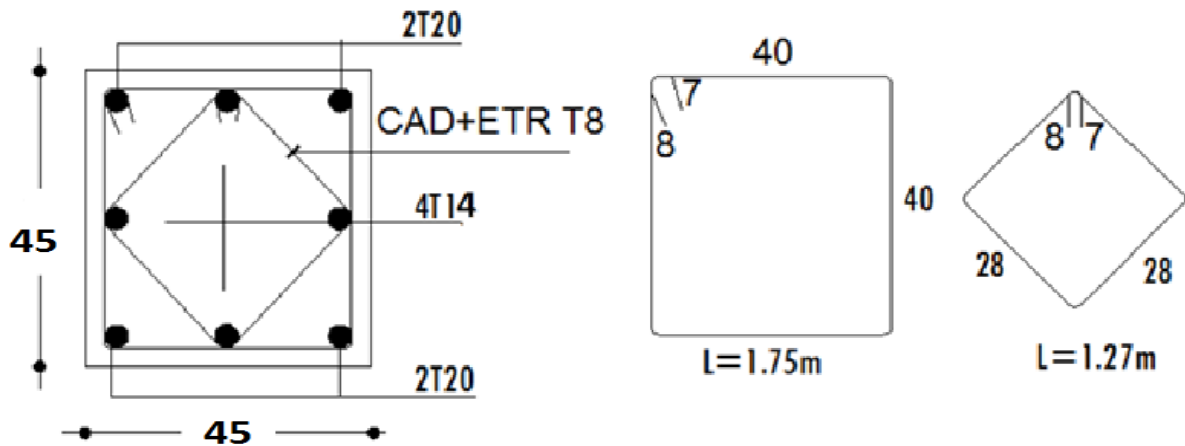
Coupe du ferrailage des poteaux 45x45
